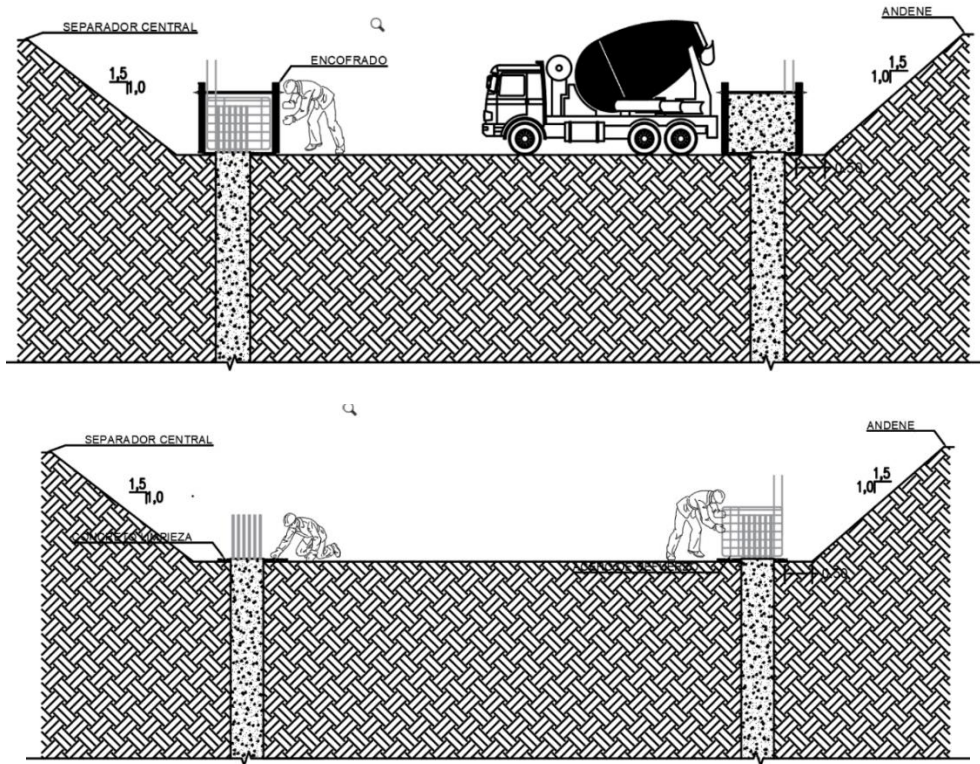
Proceso constructivo muros pantallas estación de Bombeo Subterránea.
